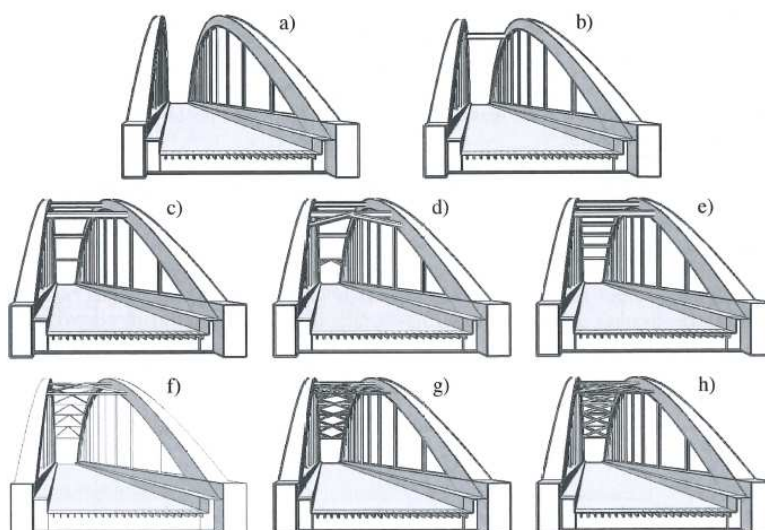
Stuženie oblúkových mostov s hornou mostovkou [13]
